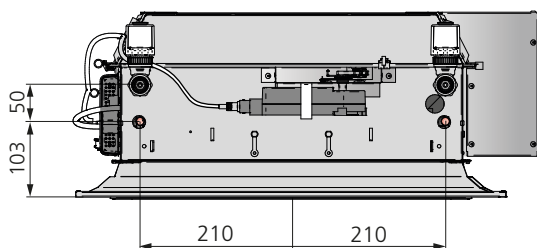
Dimensions, longueur du raccord hydraulique 600, 1200, 1800
